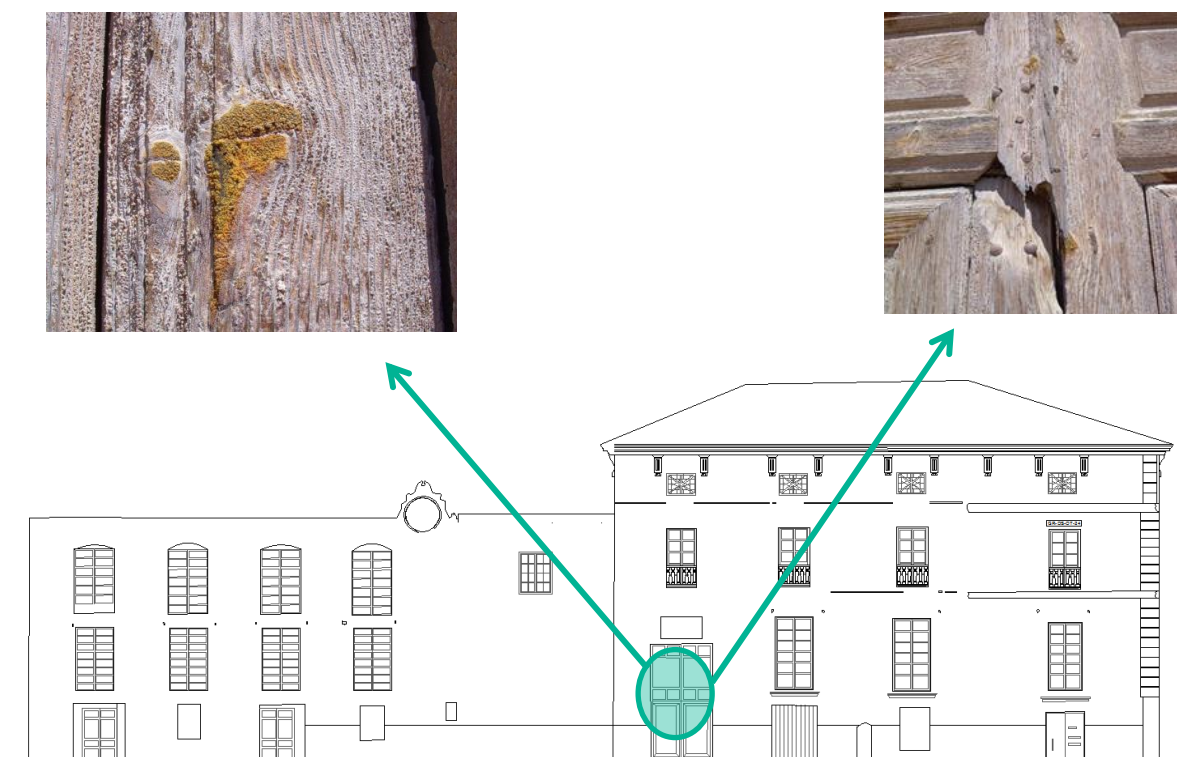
Alzado plaza. Mohos. Fuente: Elaboración propia
